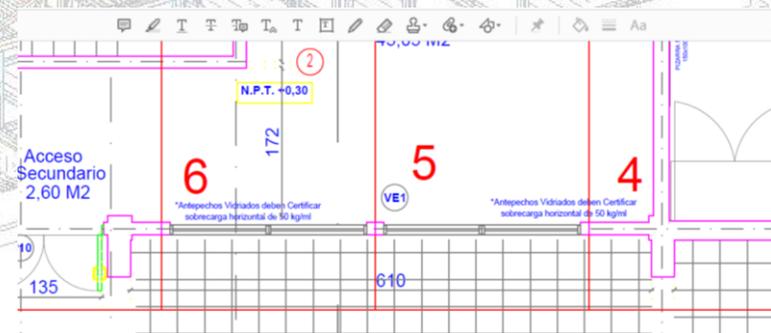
Planta Modificada hacia fachada OESTE. Elaboración propia.
